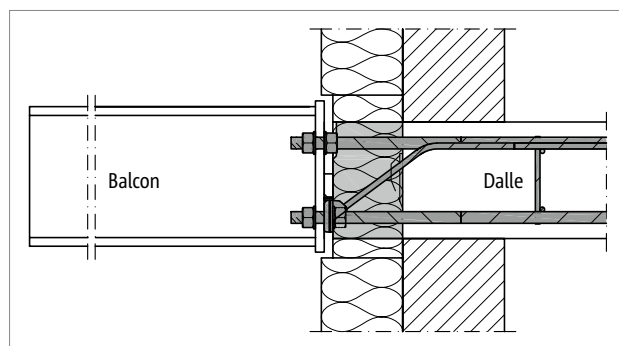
Schöck Isokorb® XT type SK : raccordement à la dalle en béton armé ; corps isolant à l'intérieur de l'isolation thermique extérieure
